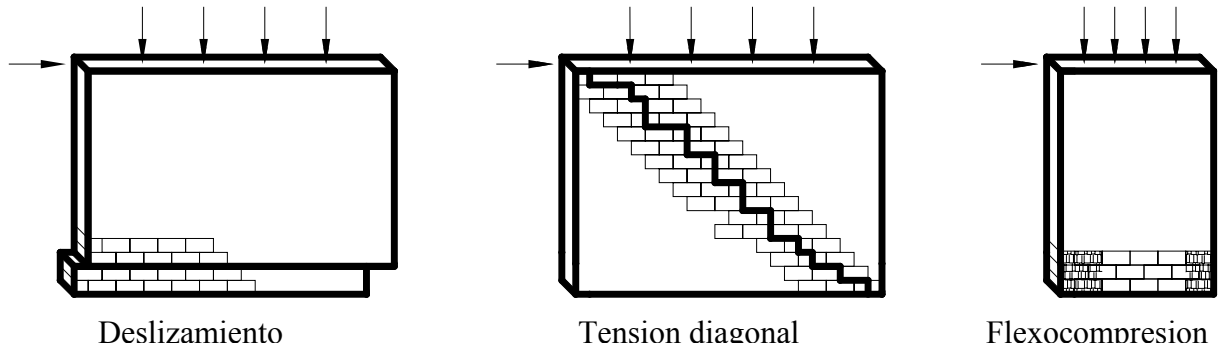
Modos de falla en un muro de mampostería (Tomažević, 1997).
